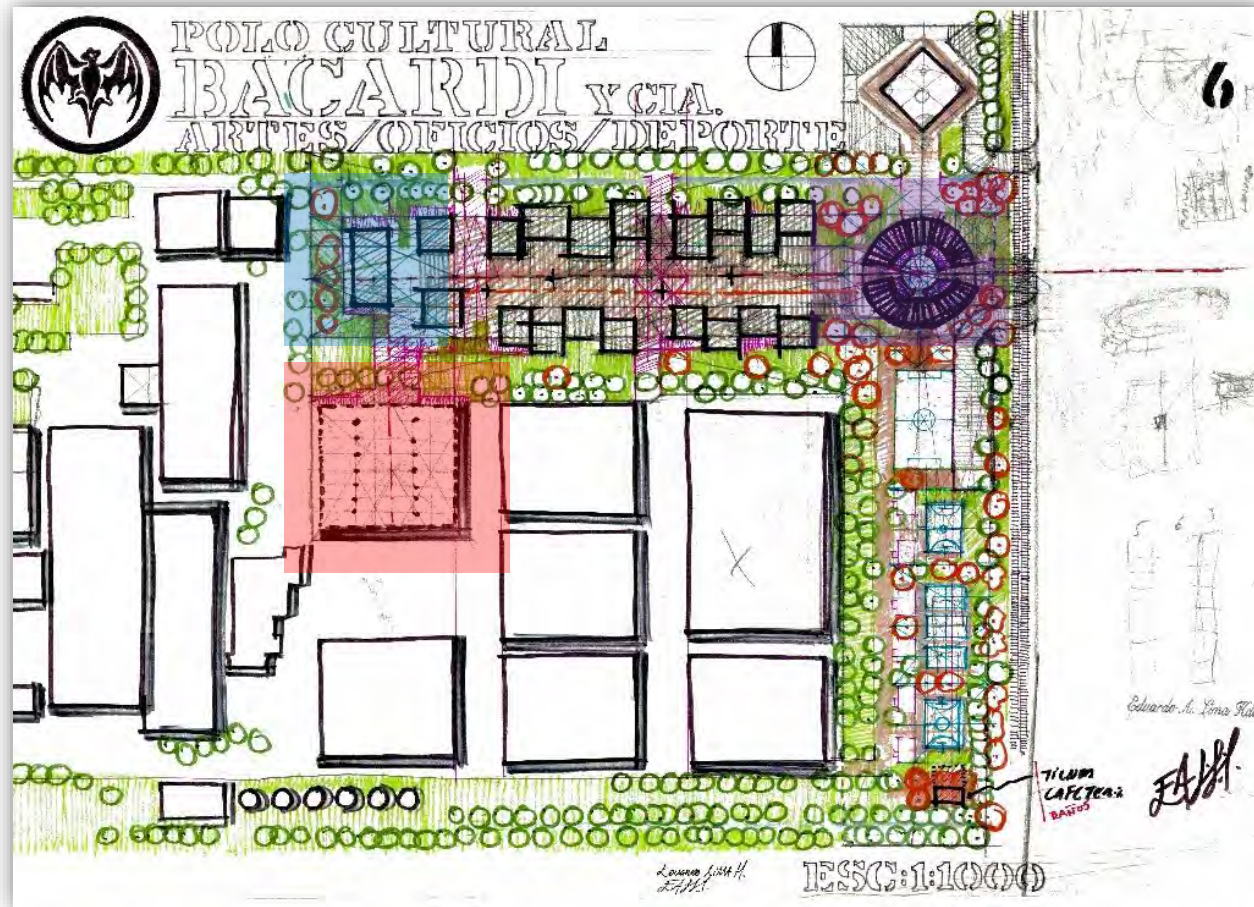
Segunda planta General de Conjunto Mayo 2018 (detalle)
